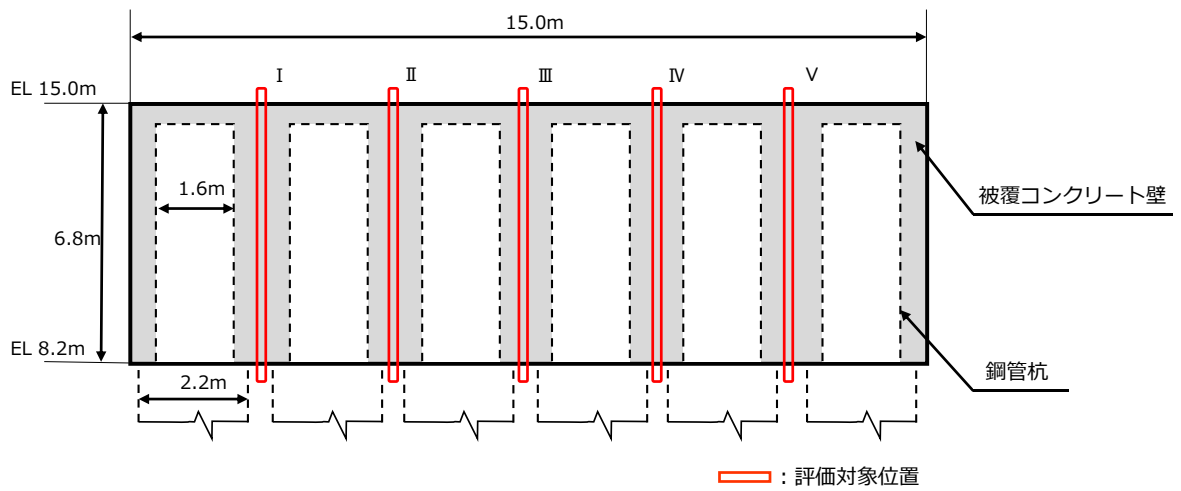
(4) 評価対象位置図 (②-②断面 正面図)
